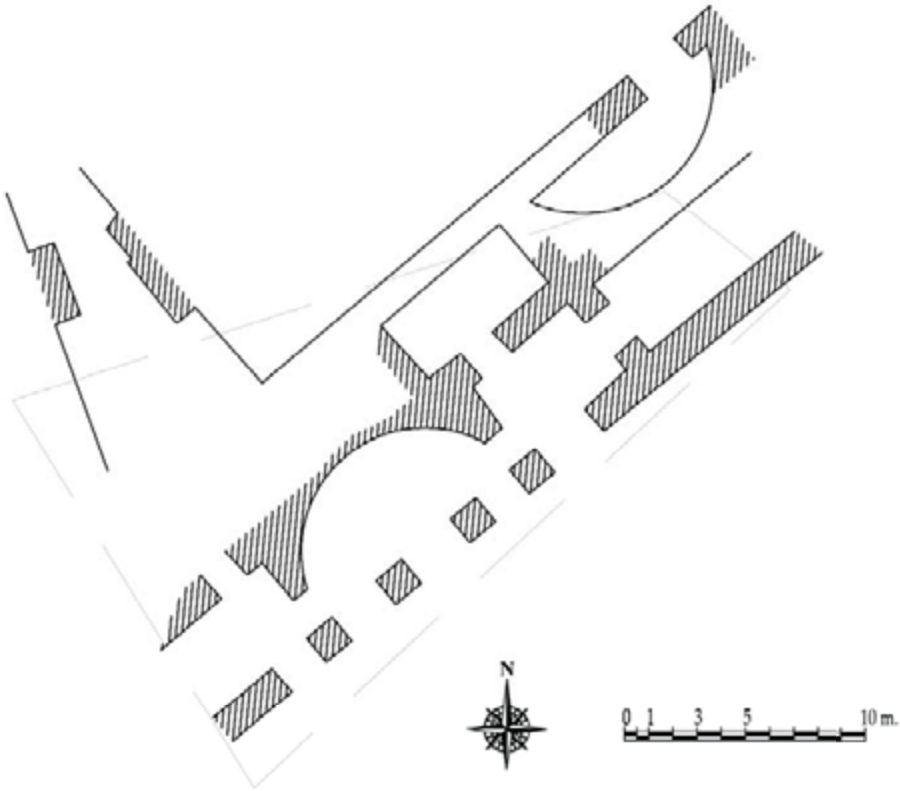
Estructuras encontradas en las excavaciones de 1932 bajo el Palazzo Desideri.
